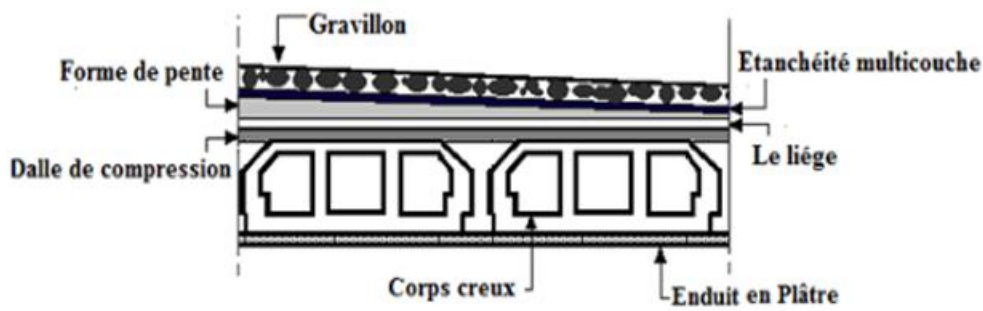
Plancher Corps creux Terrasse inaccessible
